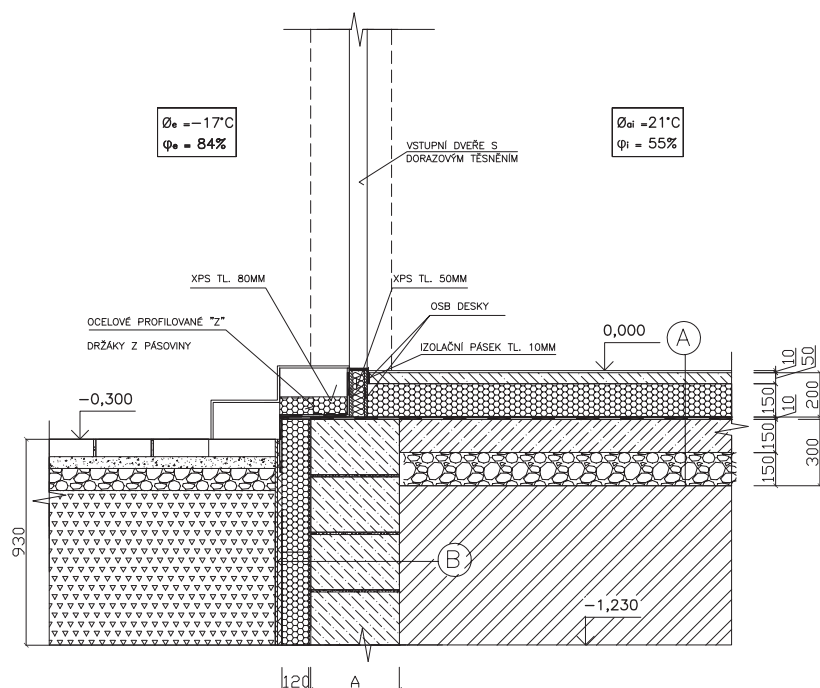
detail zdiva u základu nepodsklepeného objektu s úrovní podlahy 300 mm nad terémem
